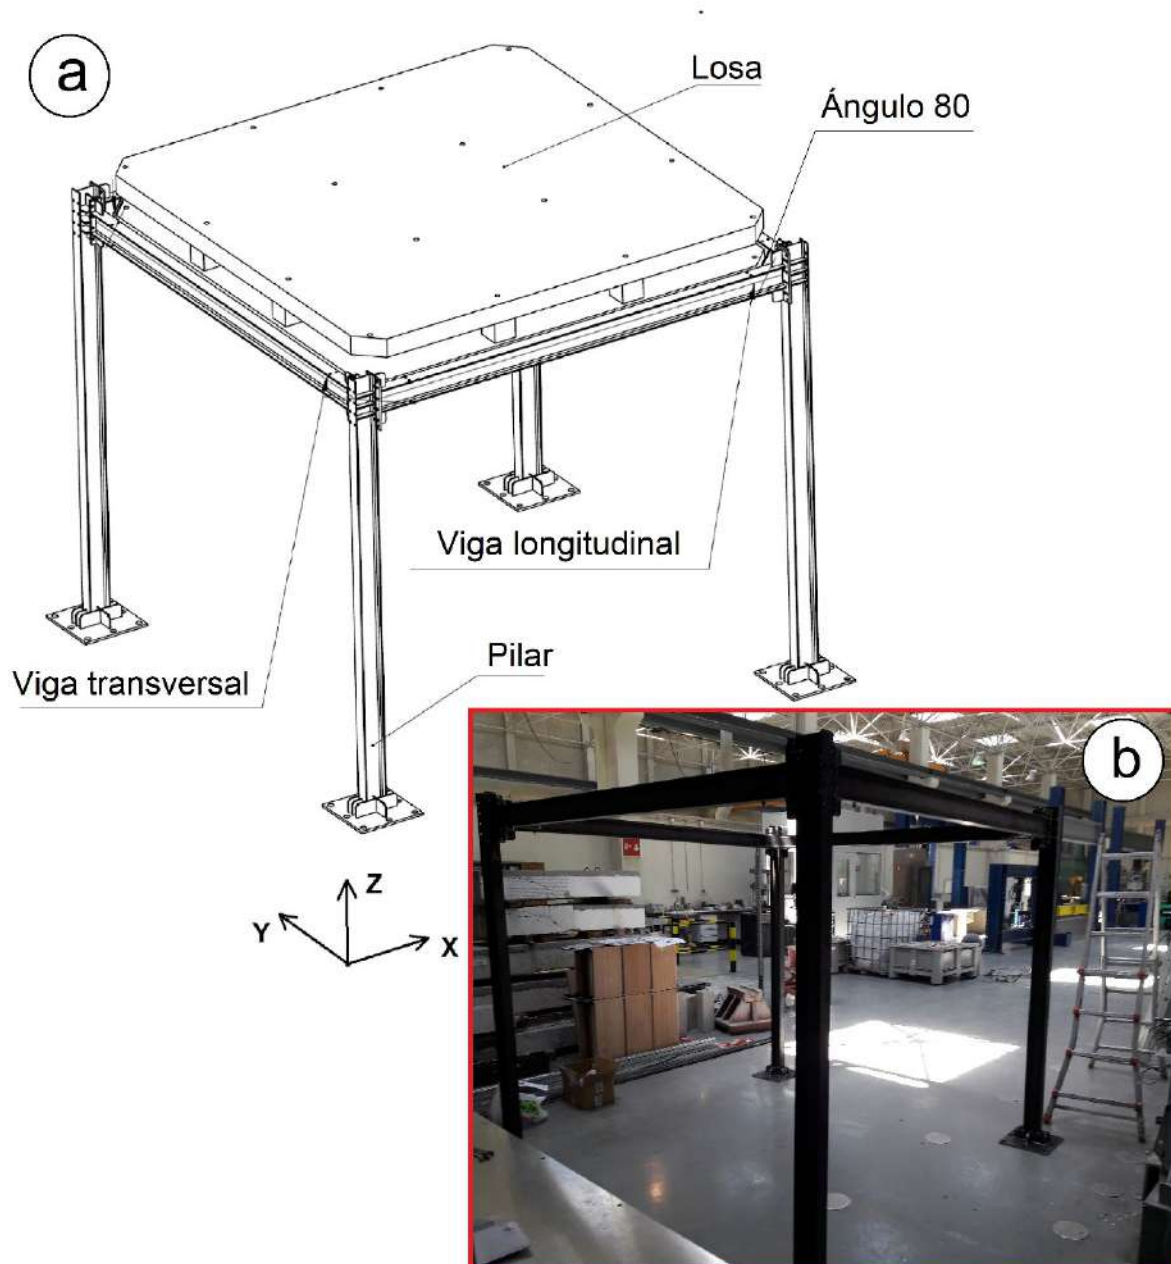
Pórtico ensayado en laboratorio. a) Modelo 3D del pórtico ensayado. b) Estructura del pórtico ensayado sin las losas de hormigón montadas.
